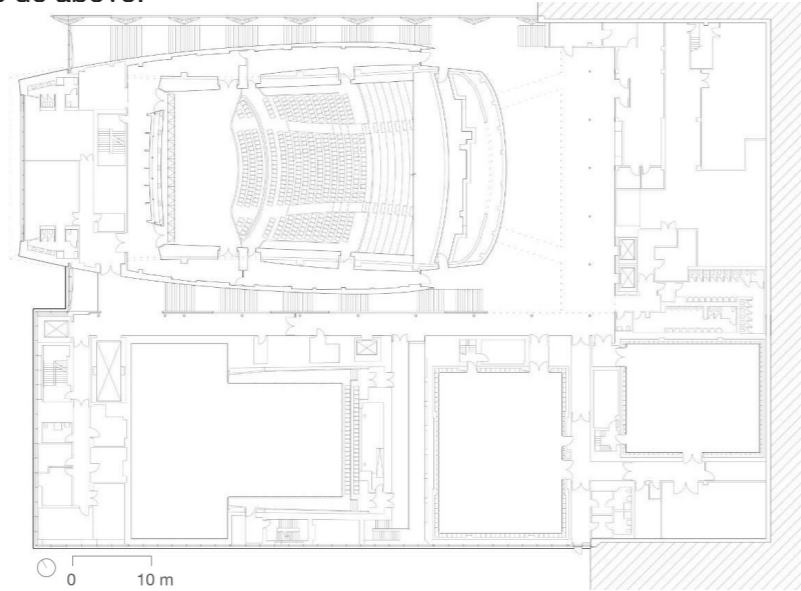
| Planta Segunda EMPAC. Fuente: Grimshaw.
